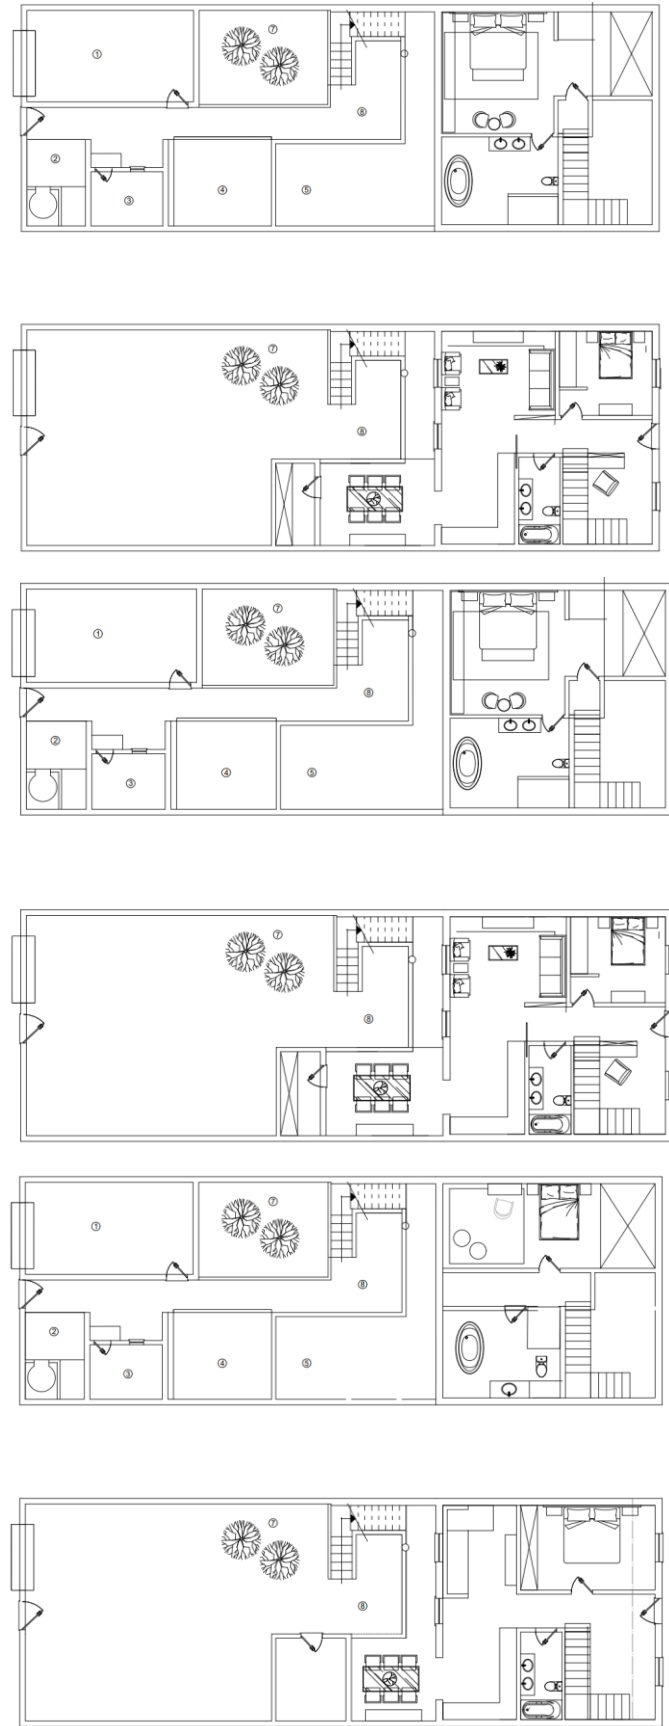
Plantas de Estudo realizadas no autocad , Fonte: Autor
